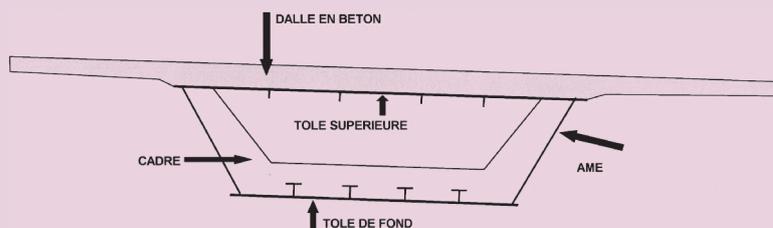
Caisson simple fermé (cas d'une chaussée monodévers)
